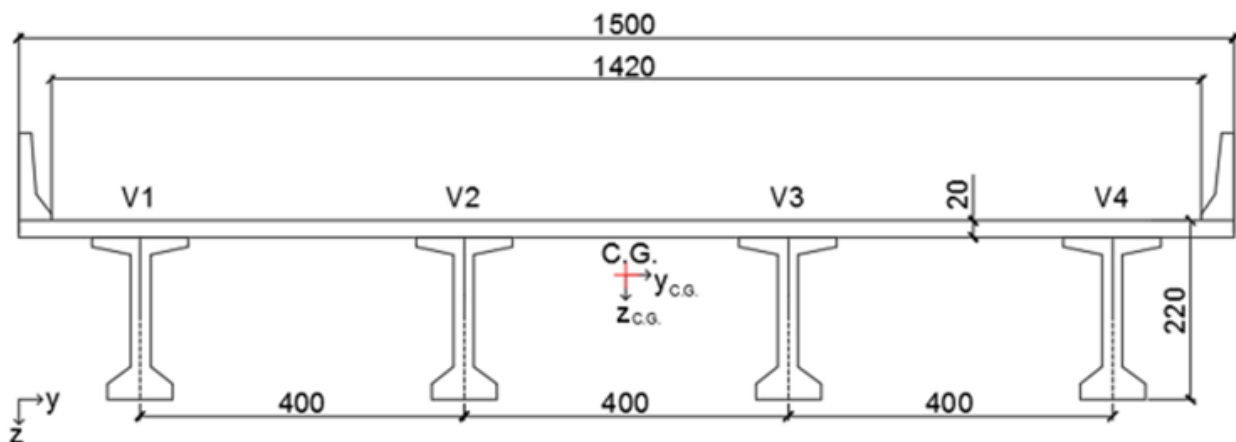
Seção transversal em vigas T pré-moldadas (seção 01)
